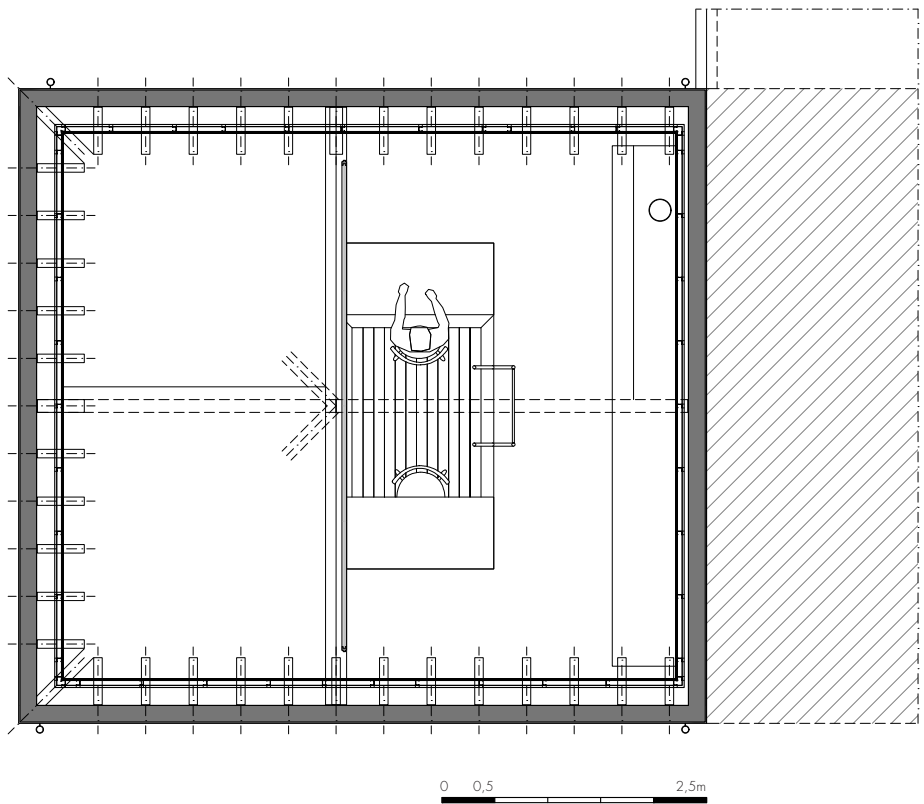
planta do mezanino - Casa 'A' tipo I
